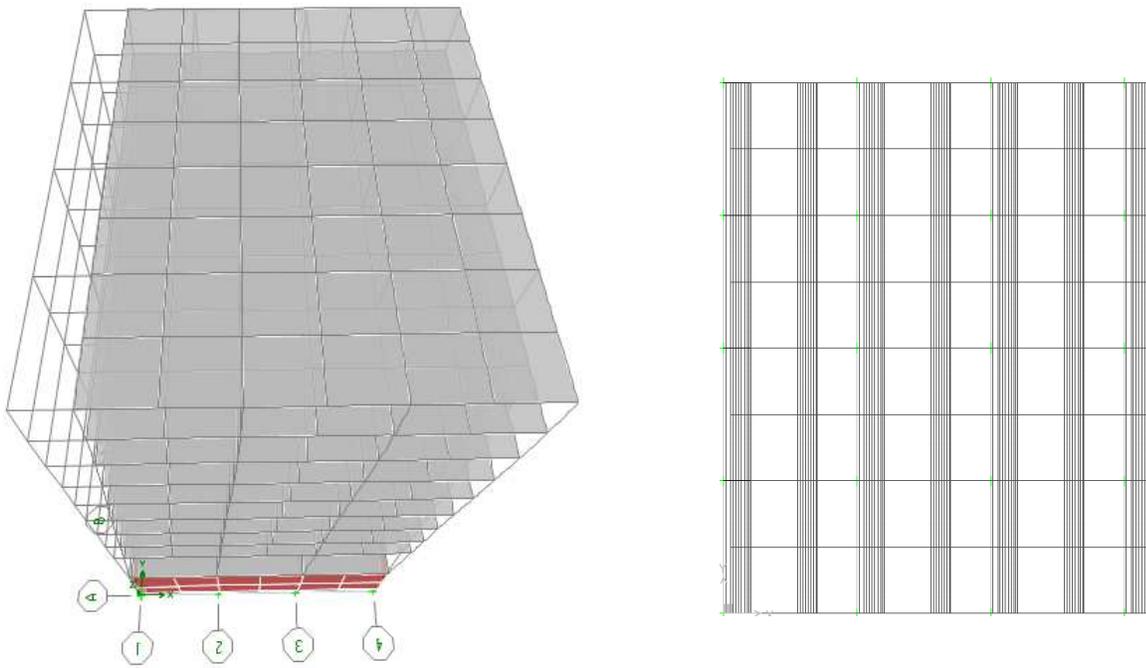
Vista en elevación y planta de la deformada del primer modo de vibrar del edificio de 9 niveles
